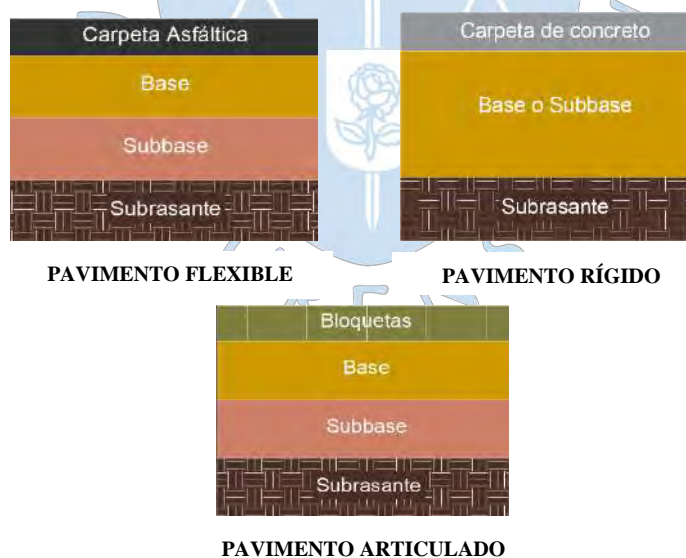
Esquemas de paquete estructural para pavimentos flexibles, rígidos y articulado.
